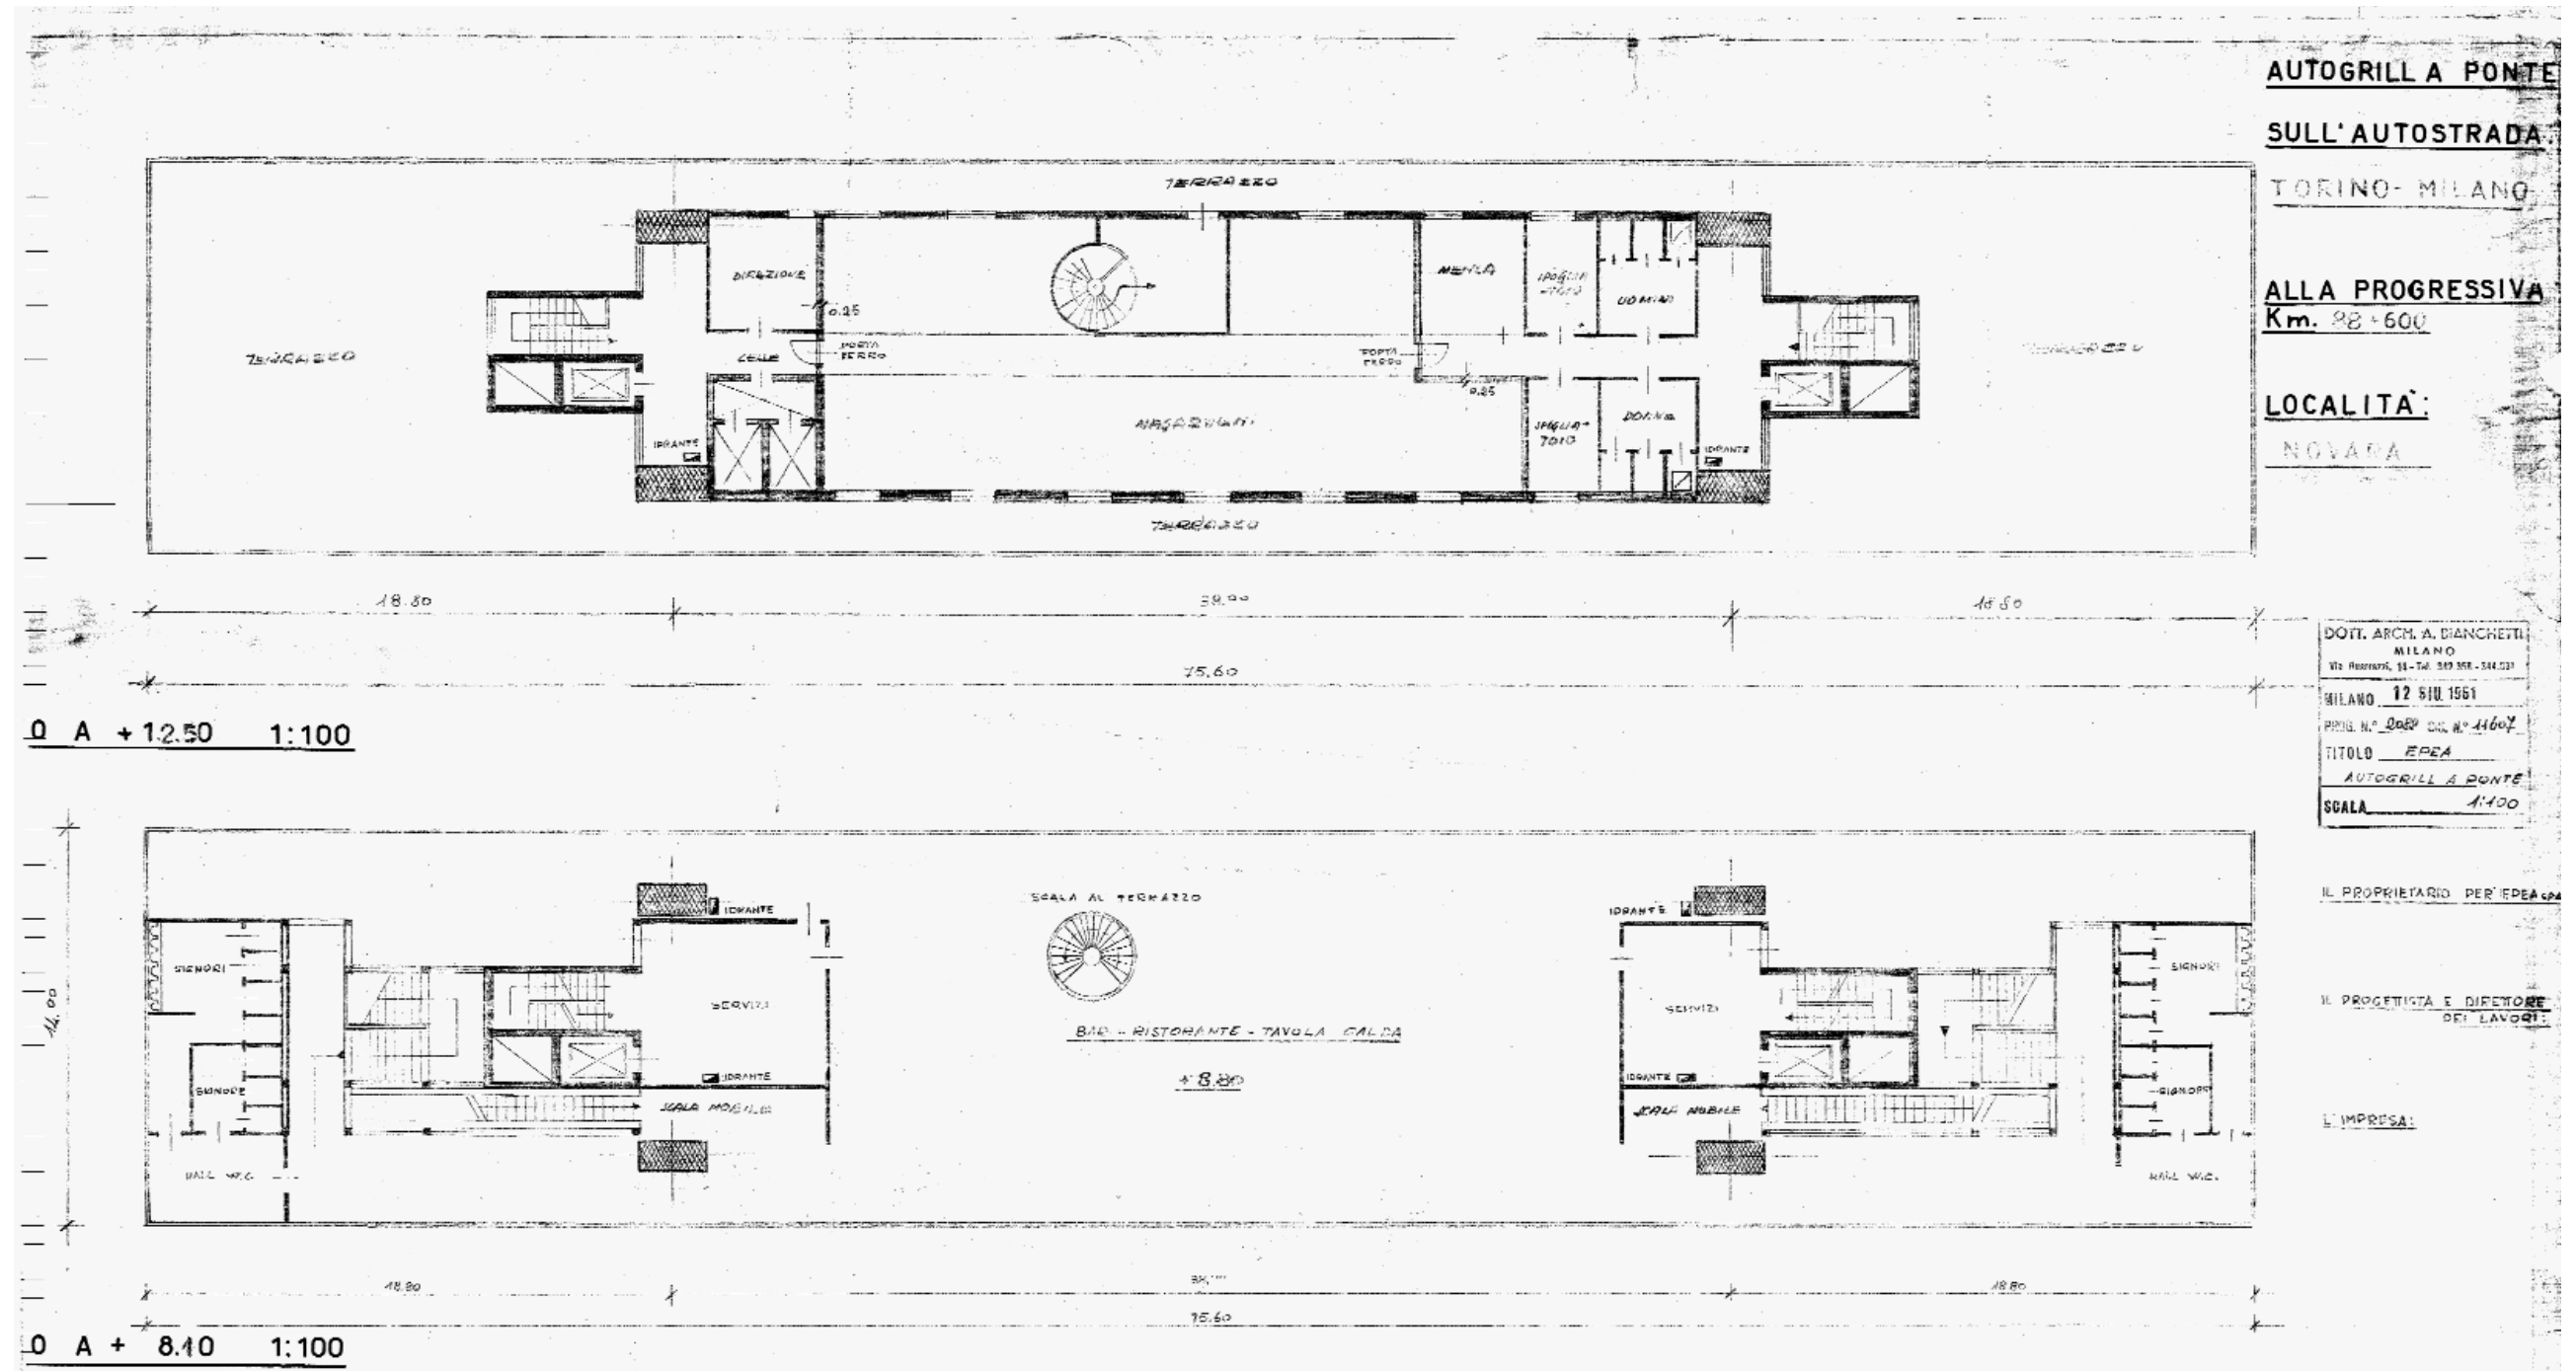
/a - L'autogrill Pavese di Novara. Pianta del piano magazzini (in alto) e del piano ristorante (AAB)
